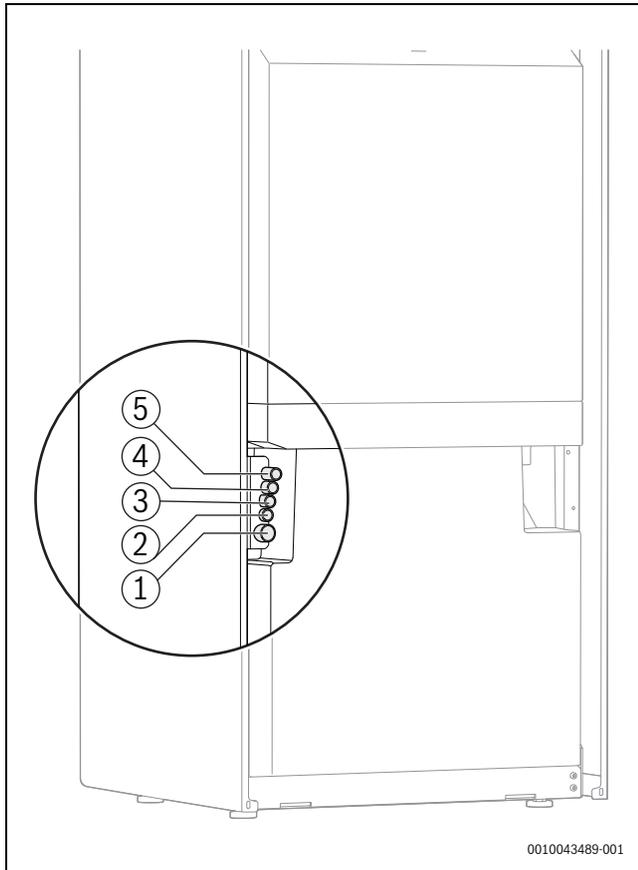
Vista posteriore: passacavo del cavo di rete nell'unità interna
